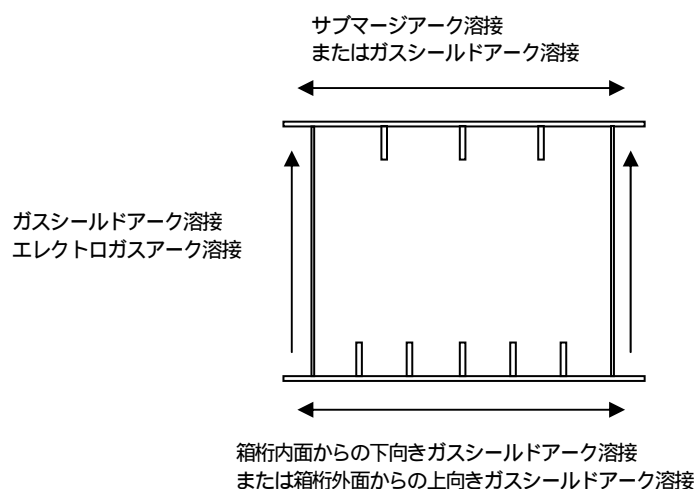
鋼橋現場全断面溶接の施工例
